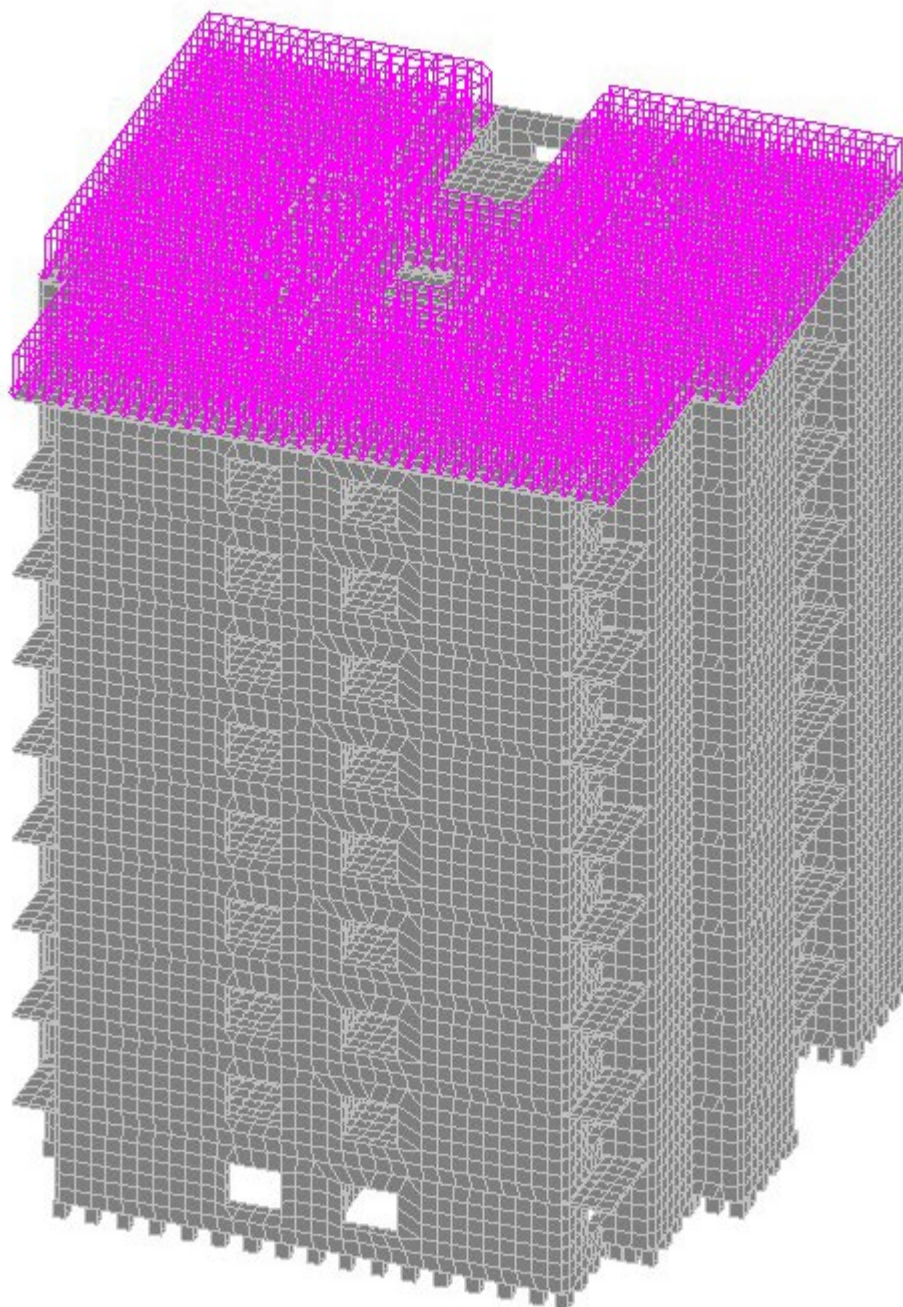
Нагрузка от собственного веса конструкций кровли
